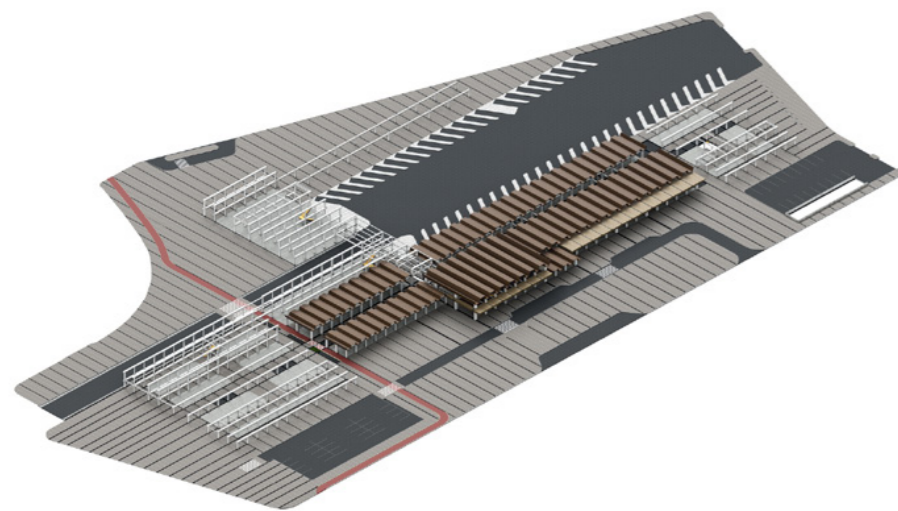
Estado Estructural, modulación de vigas y columnas. Fuente propia
